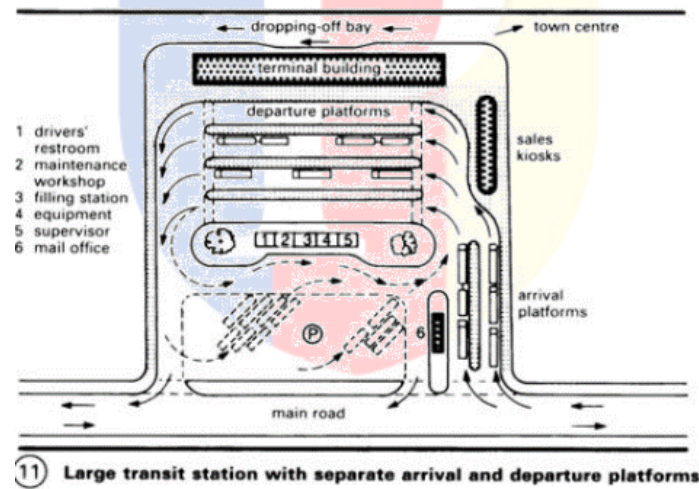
Tipikal Ruang Parkir Bus 1
